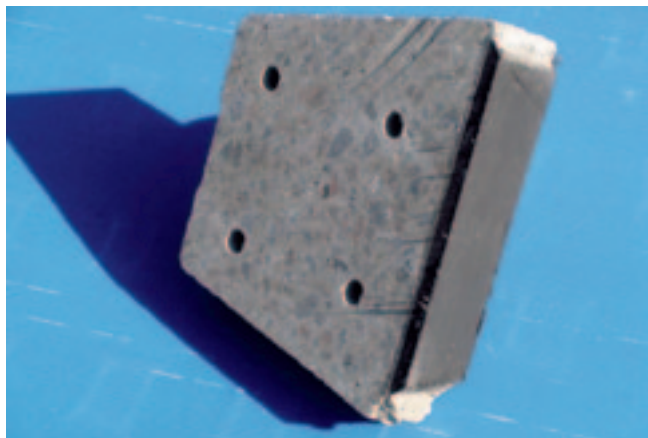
Поперечное сечение железобетонной шпалы с синтетическим покрытием подошвы толщиной 10 мм
